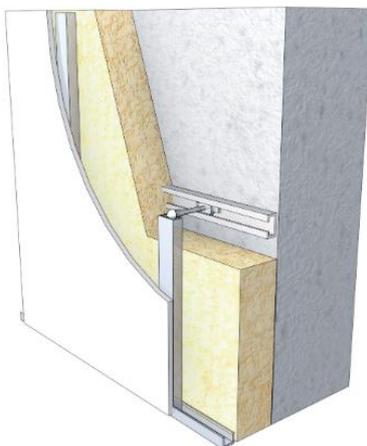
détail au droit d'un appui intermédiaire (rapport RAGE)
